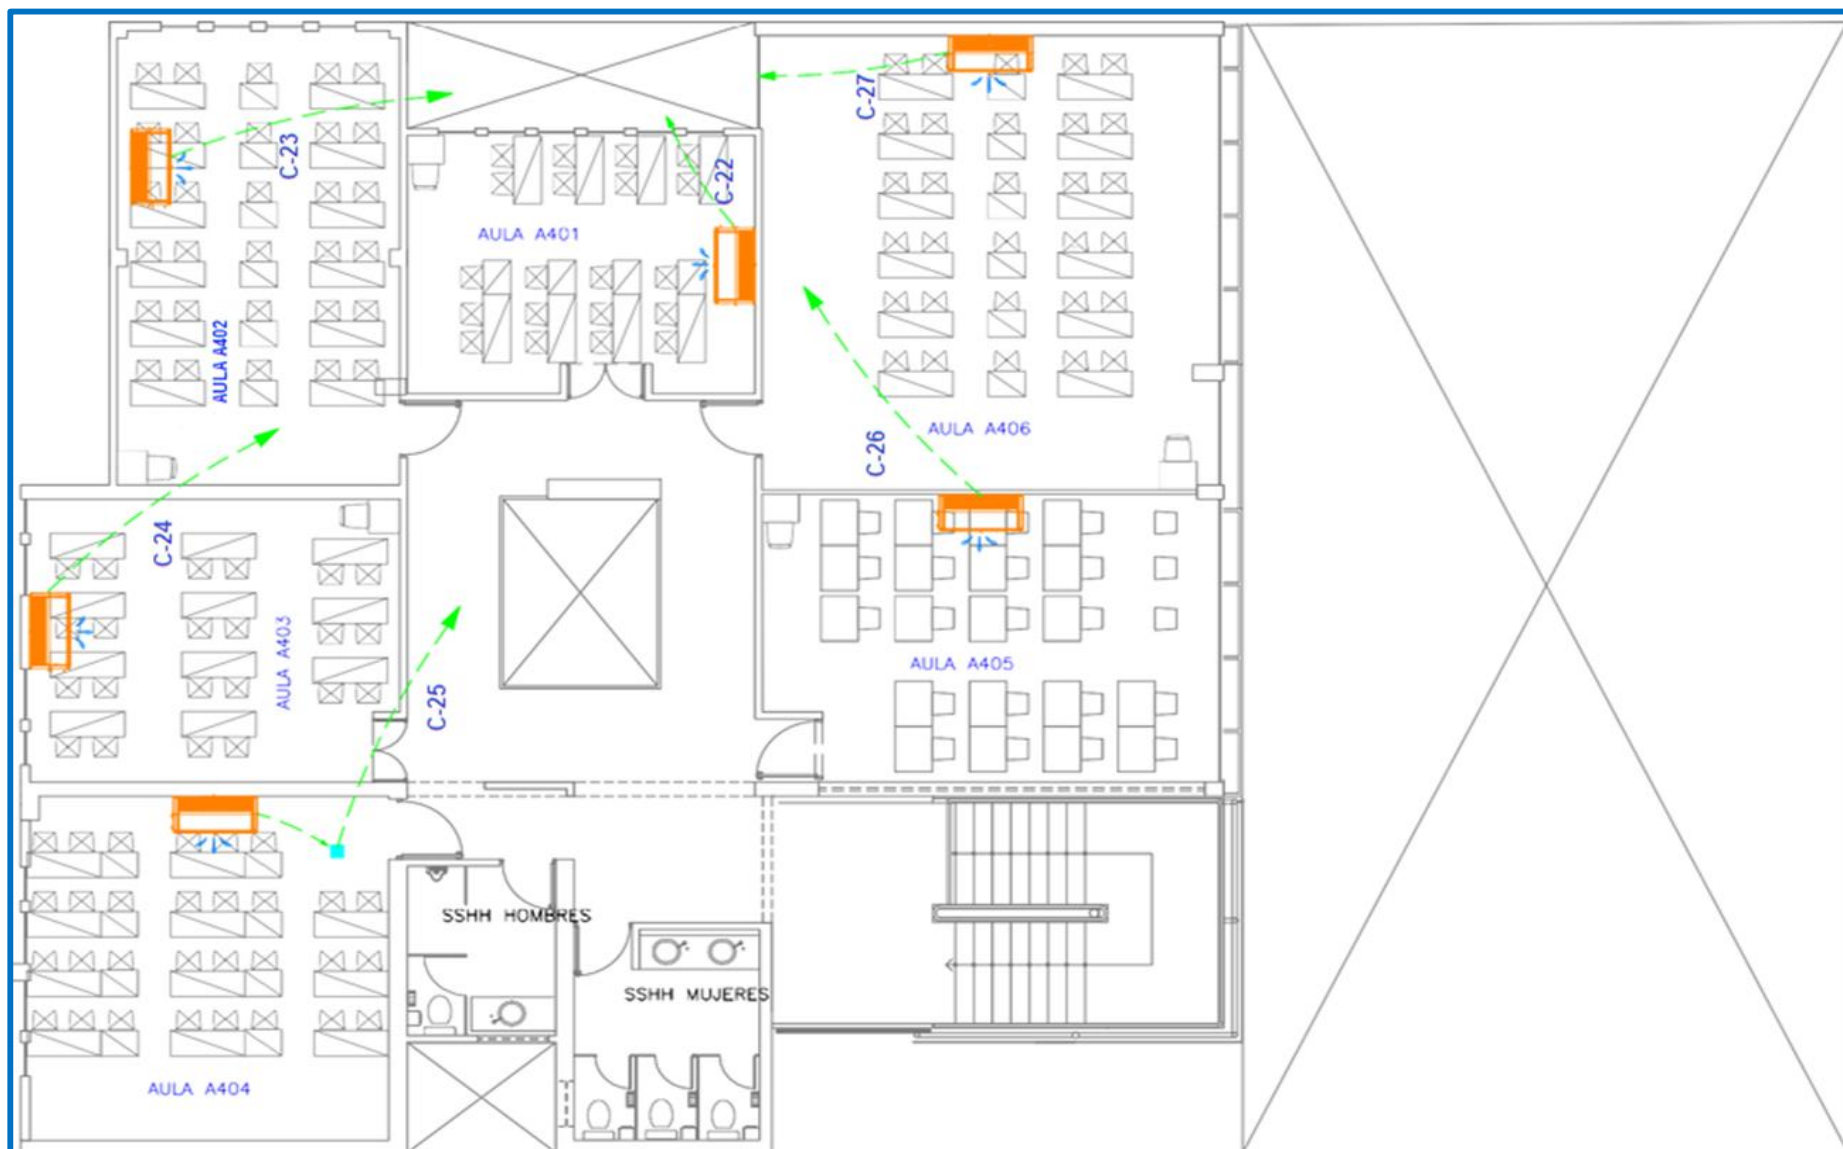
Plano de la cuarta planta – Instituto Privado Toulouse Lautrec
